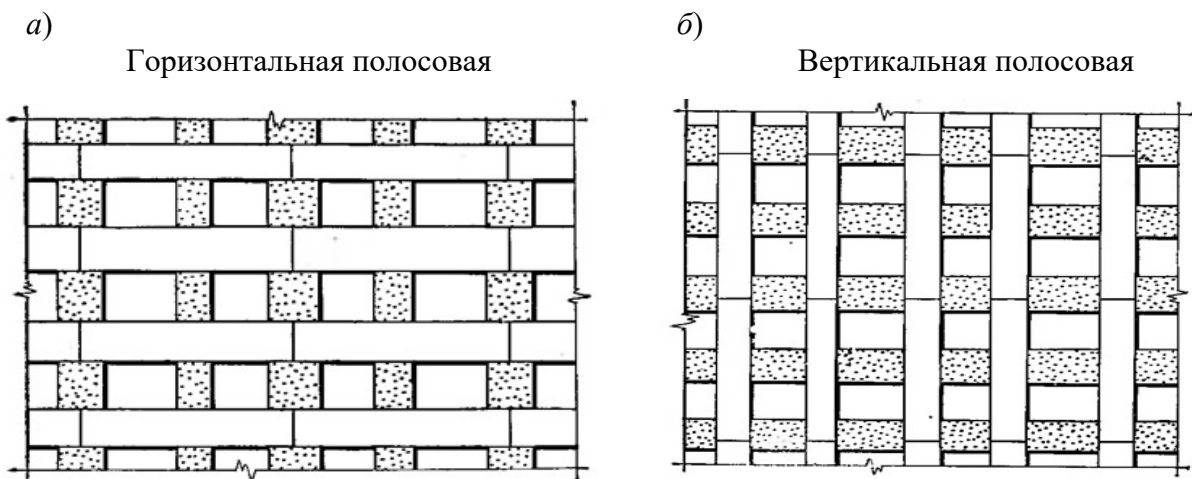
Схемы разрезки наружных стен на панели
